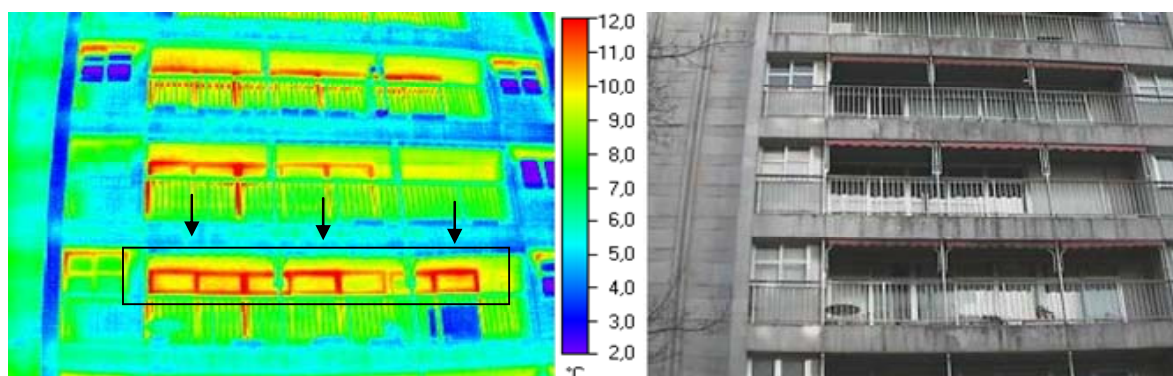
Cerramientos exteriores. Detalles ventanas aluminio
